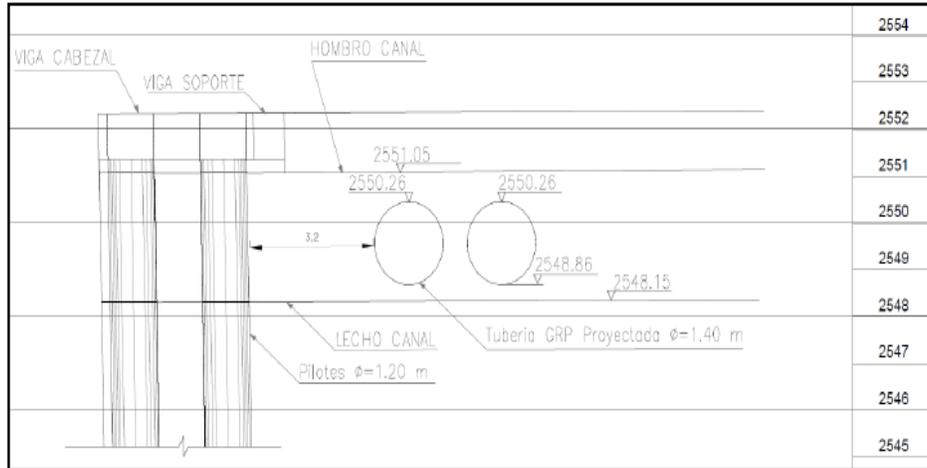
Vista transversal de la tubería oriental de 1.40 m a instalarse en el canal Torca.
